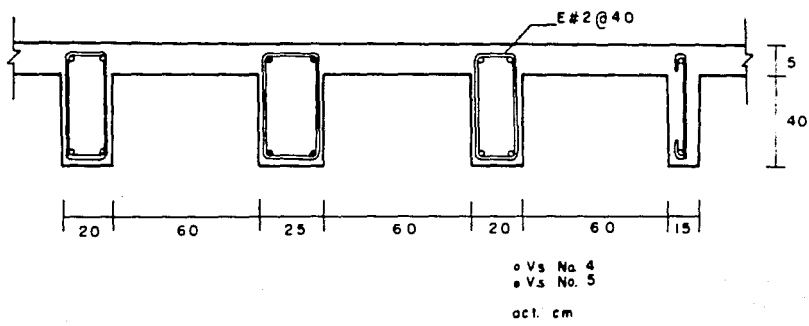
Corte de la losa y sección efectiva de las vigas según el RDF-87
